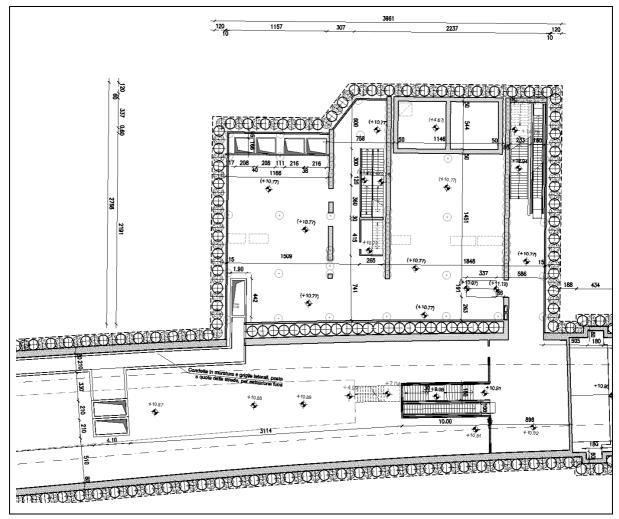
Stazione Politeama – Locali tecnici – Pianta quota mezzanino
